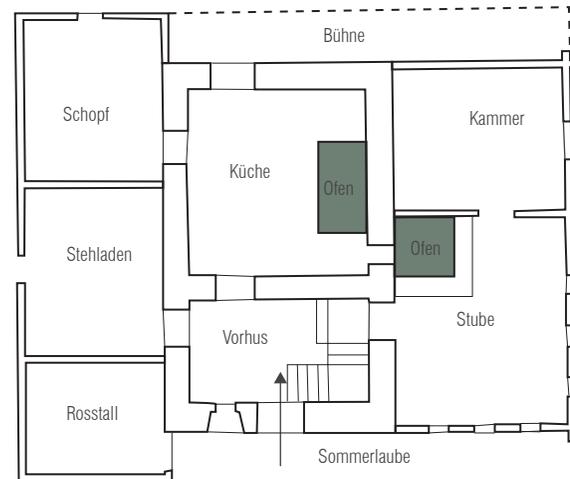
Grundriss Lech Oberstubenbach 30
